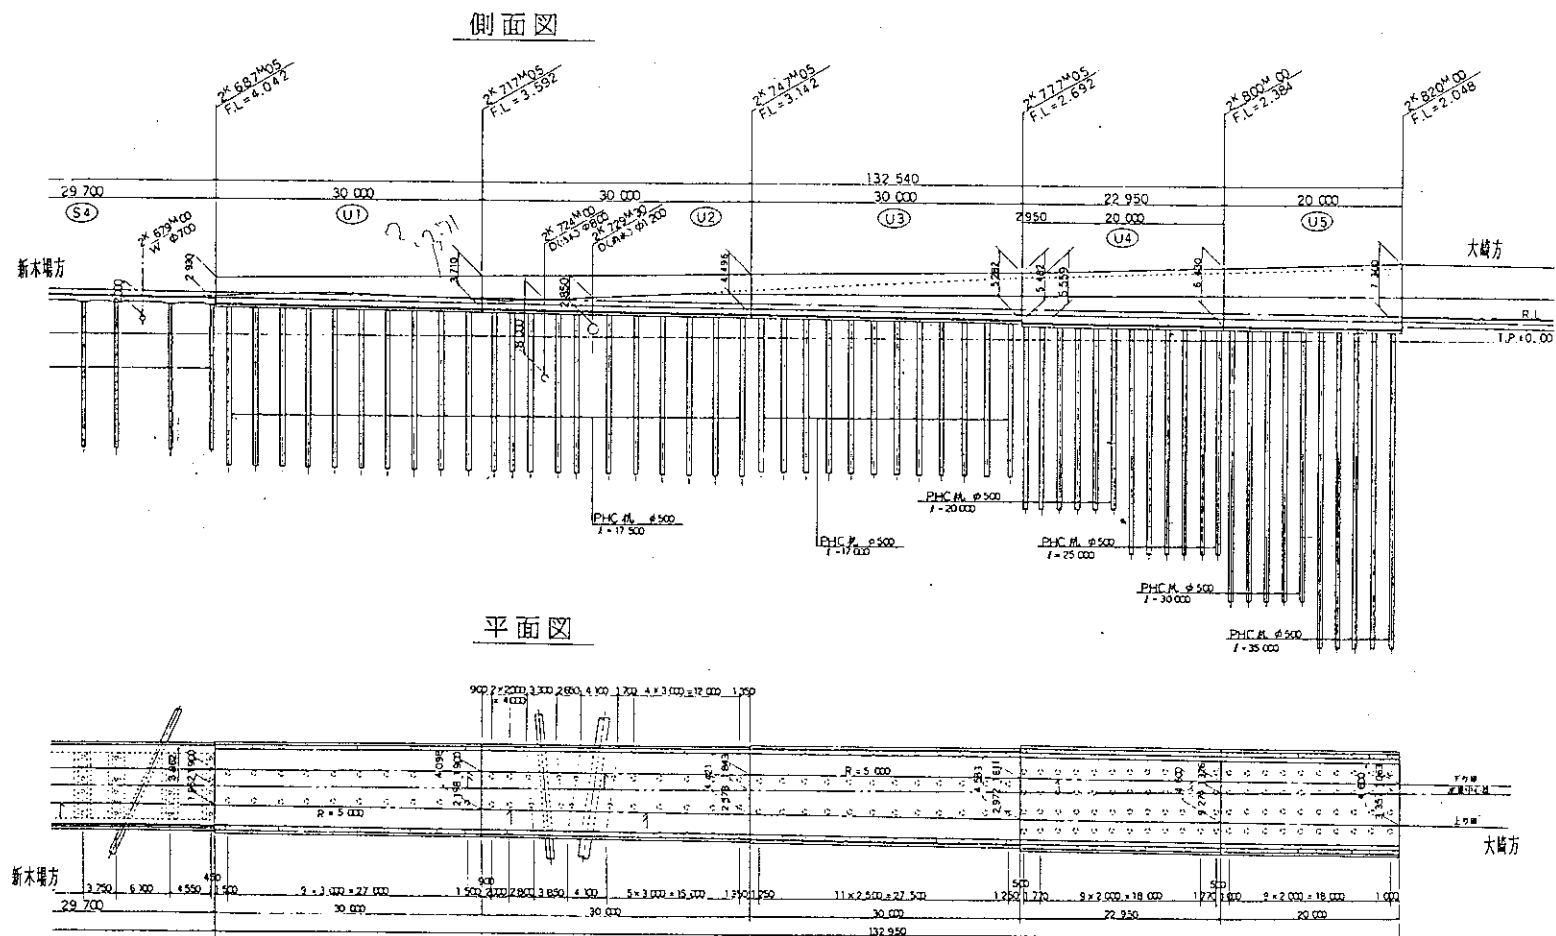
4 - 6 連続スラブ桁平面図・断面図
